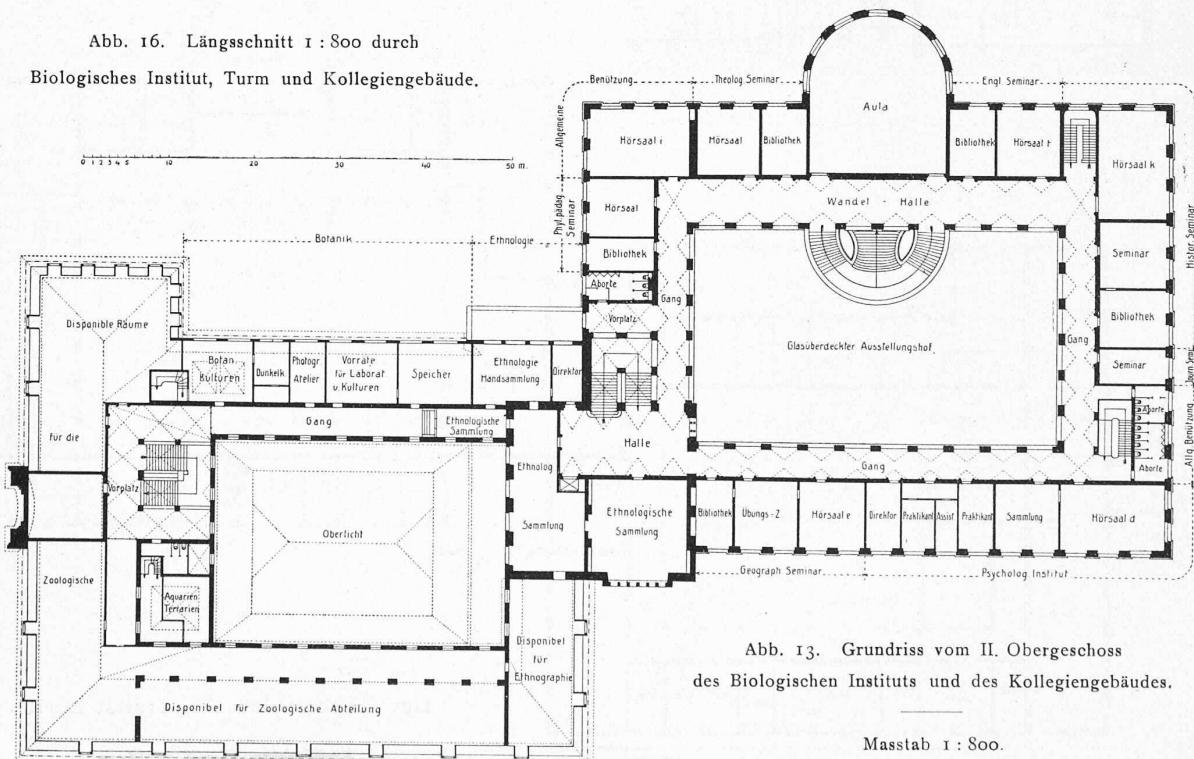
Grundriss vom II. Obergeschoss des Biologischen Instituts und des Kollegiengebäudes.
